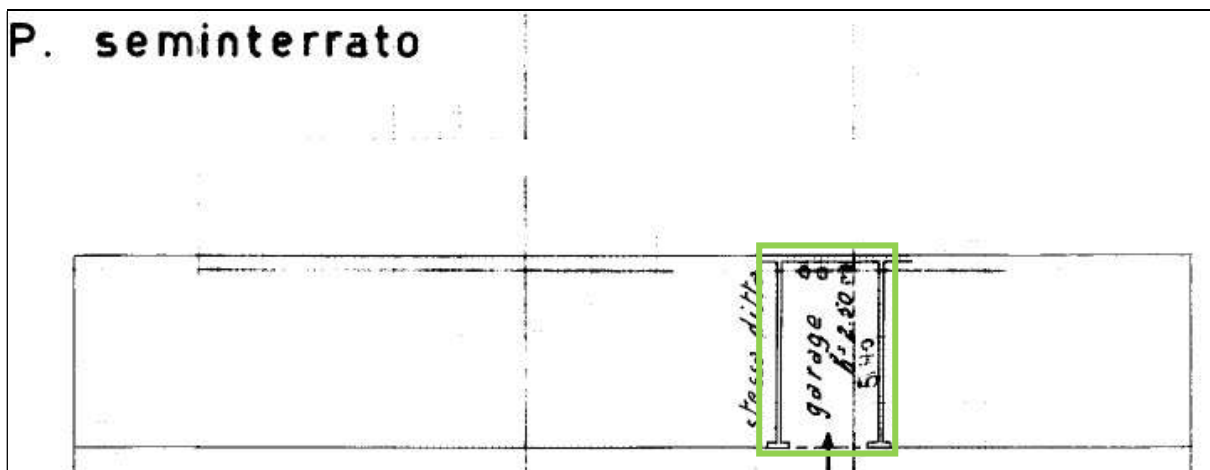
Estratto planimetria – Sez. SNA fg.6 Part. 4095 sub 5
